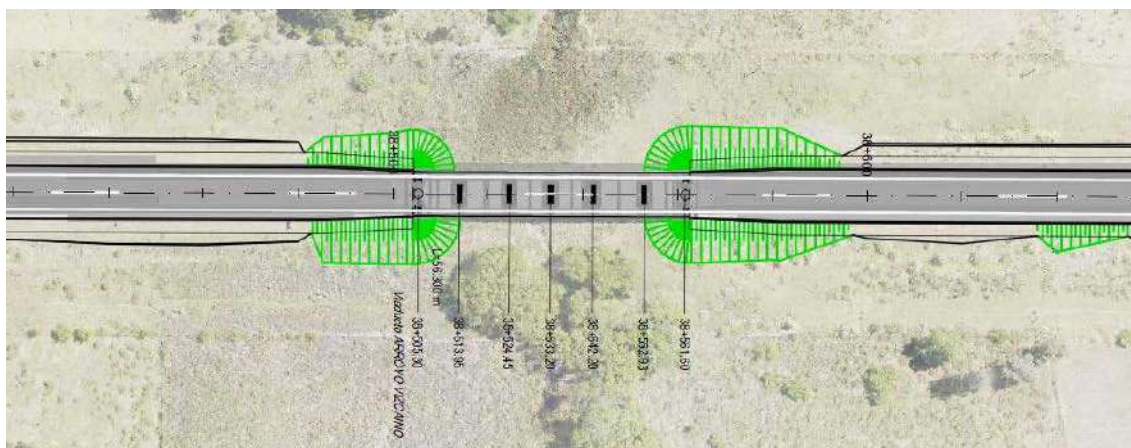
Planta de trazado para refacción de puente sobre arroyo Viscaíno.
